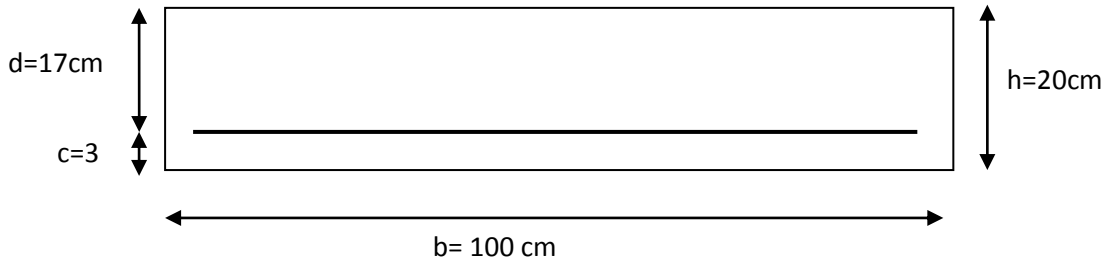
Schéma statique du ferrailage de mur plaque
